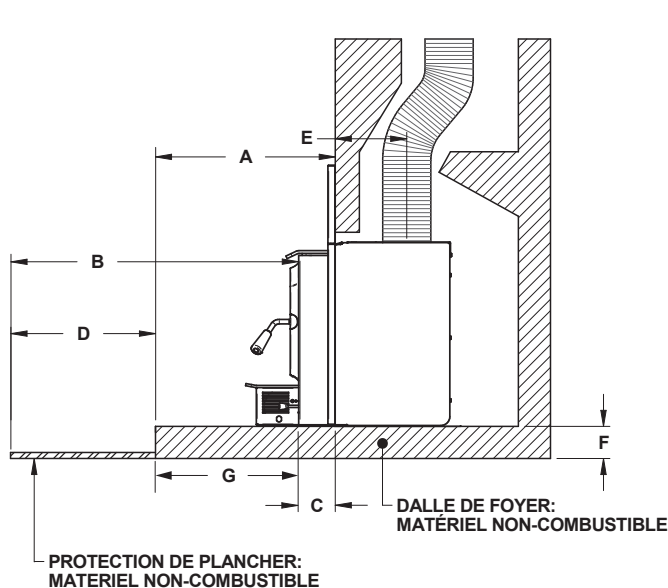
Protection de plancher aditionnelle - Installation surélevée
